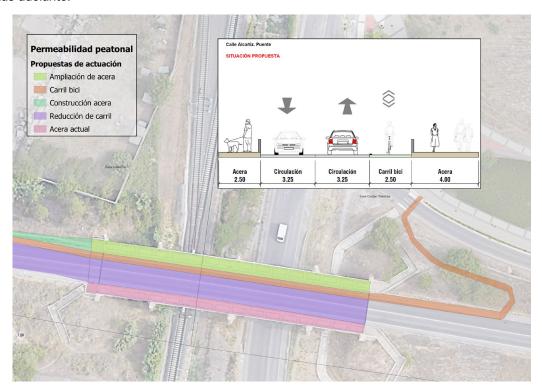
Propuesta en el puente de la C. Alcañiz
